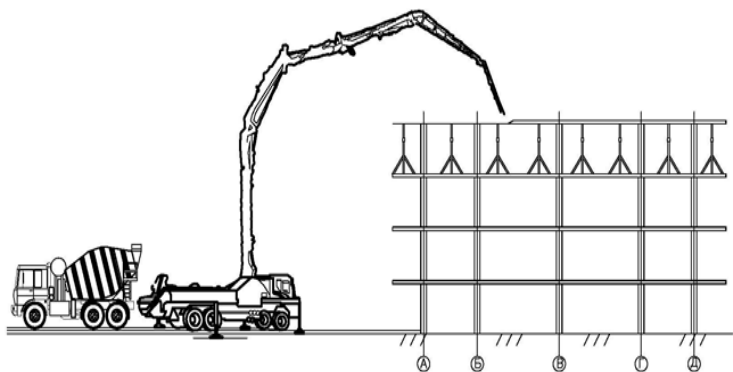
Возможная схема подачи бетона при устройстве монолитного перекрытия здания
